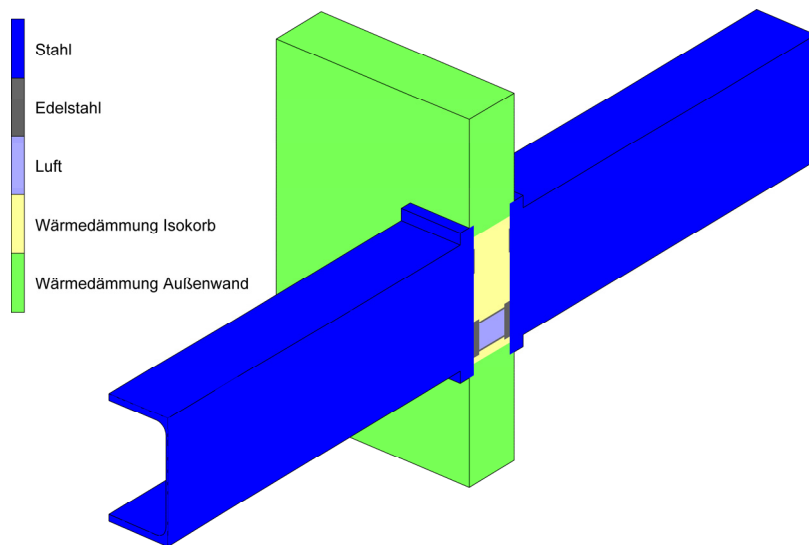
FE-Modell HEA 220 mit Schöck Isokorb Typ KST 22
